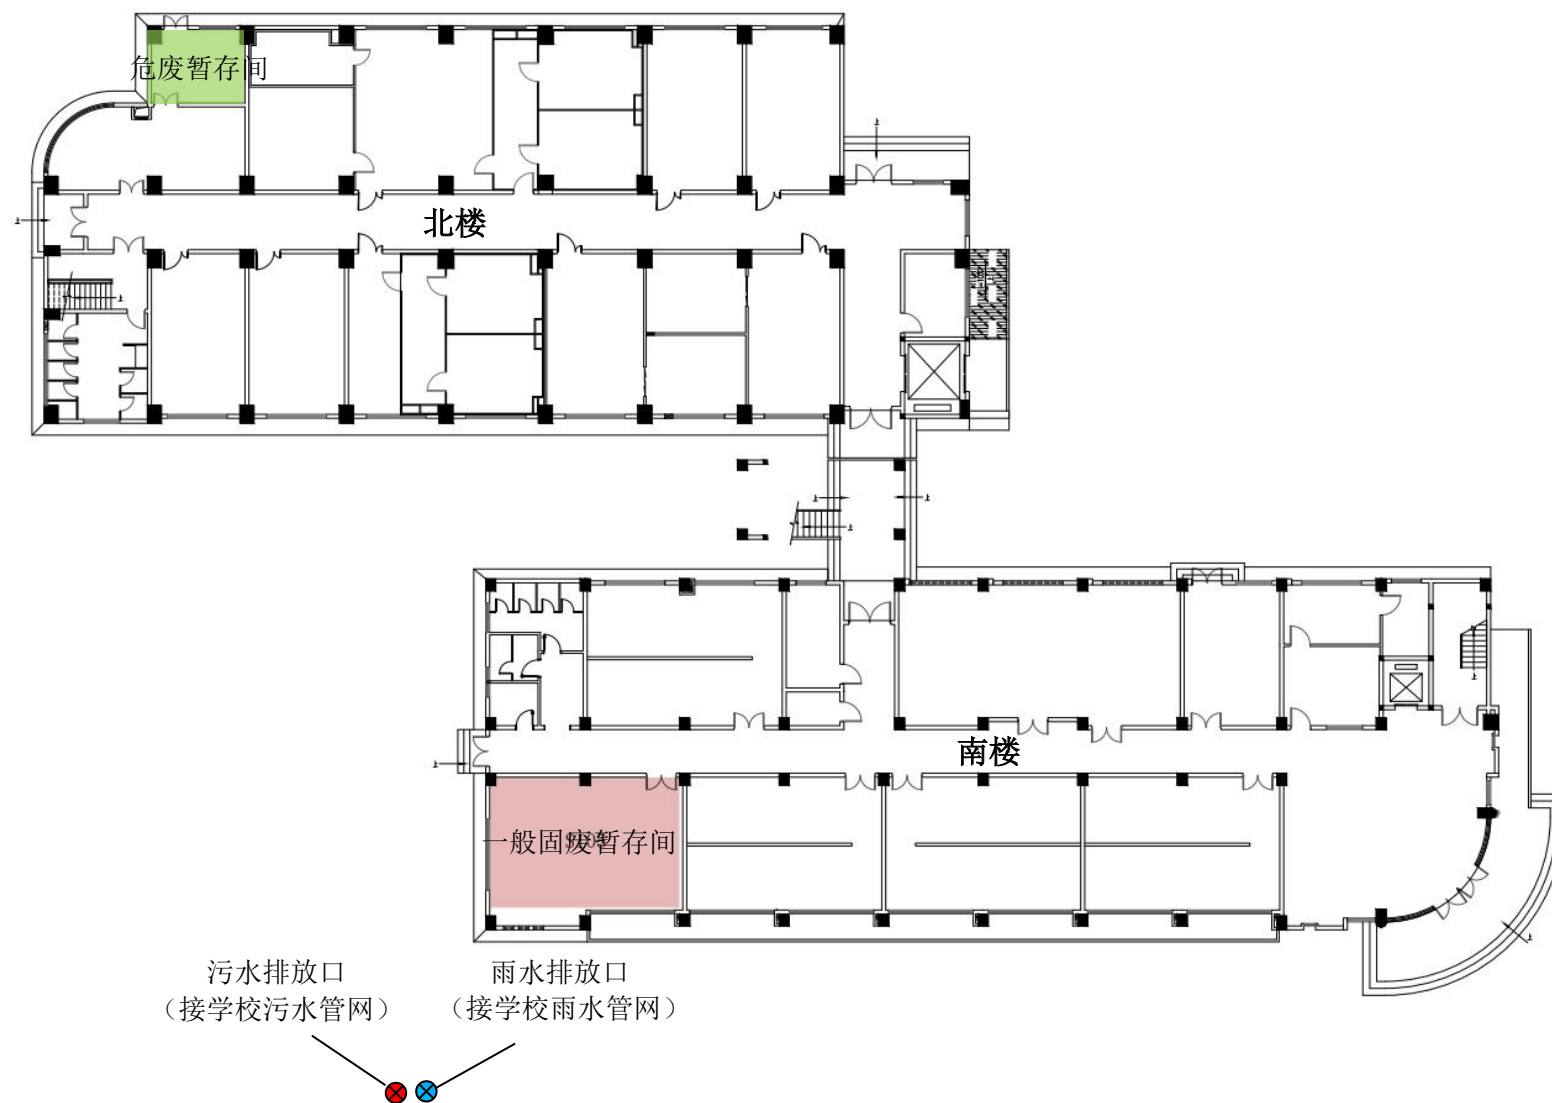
废物暂存间（科研楼 1 层）平面布置图
